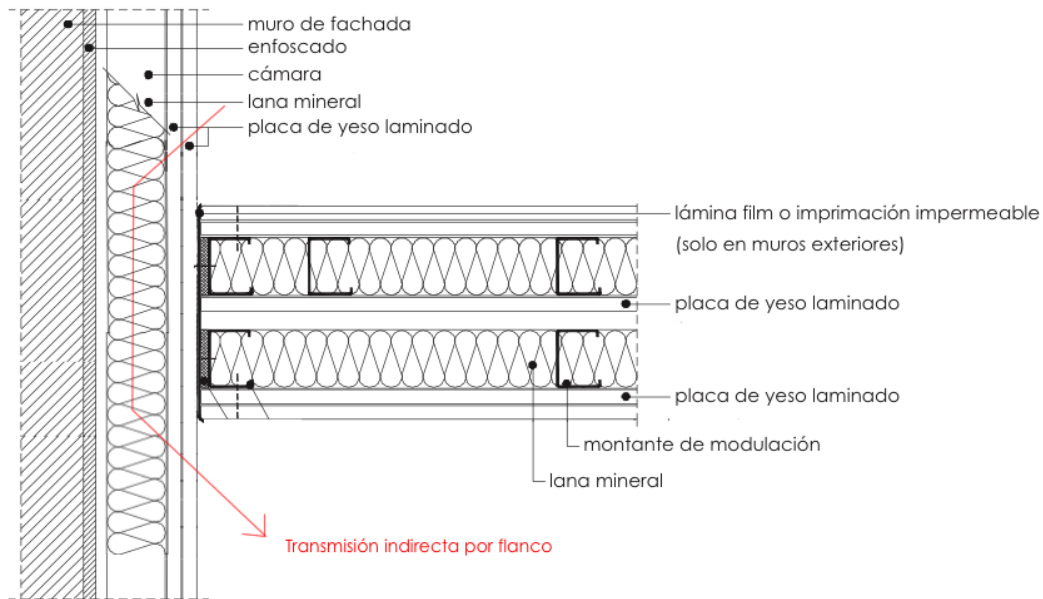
Detalle encuentro fachada y elemento de separación vertical . Transmisión indirecta a través de la hoja interior de la fachada
